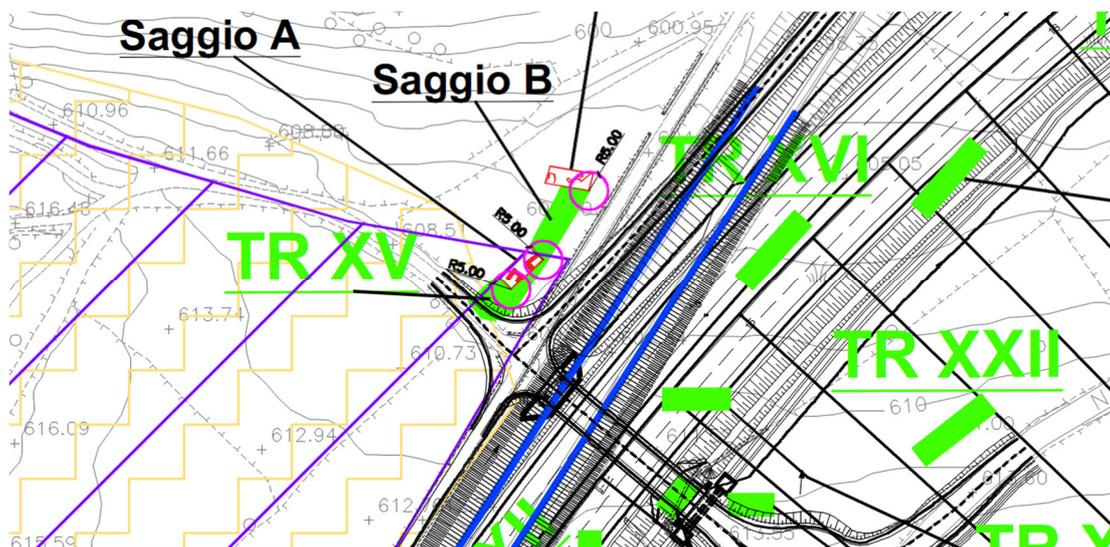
Vista generale delle aree in questione – Opere di Progetto Esecutivo
